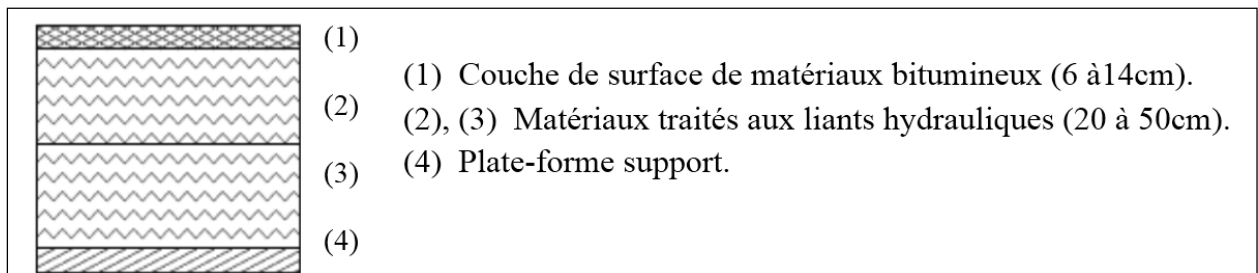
Structure d'une chaussée à assise traitée aux liants hydrauliques
